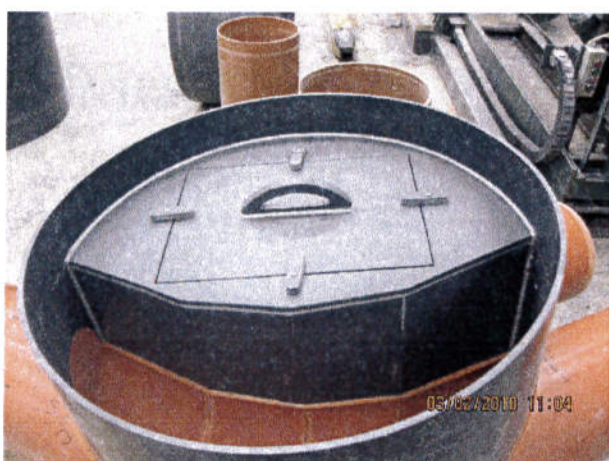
Fondo prefabbricato in PVC doppia tubazione
